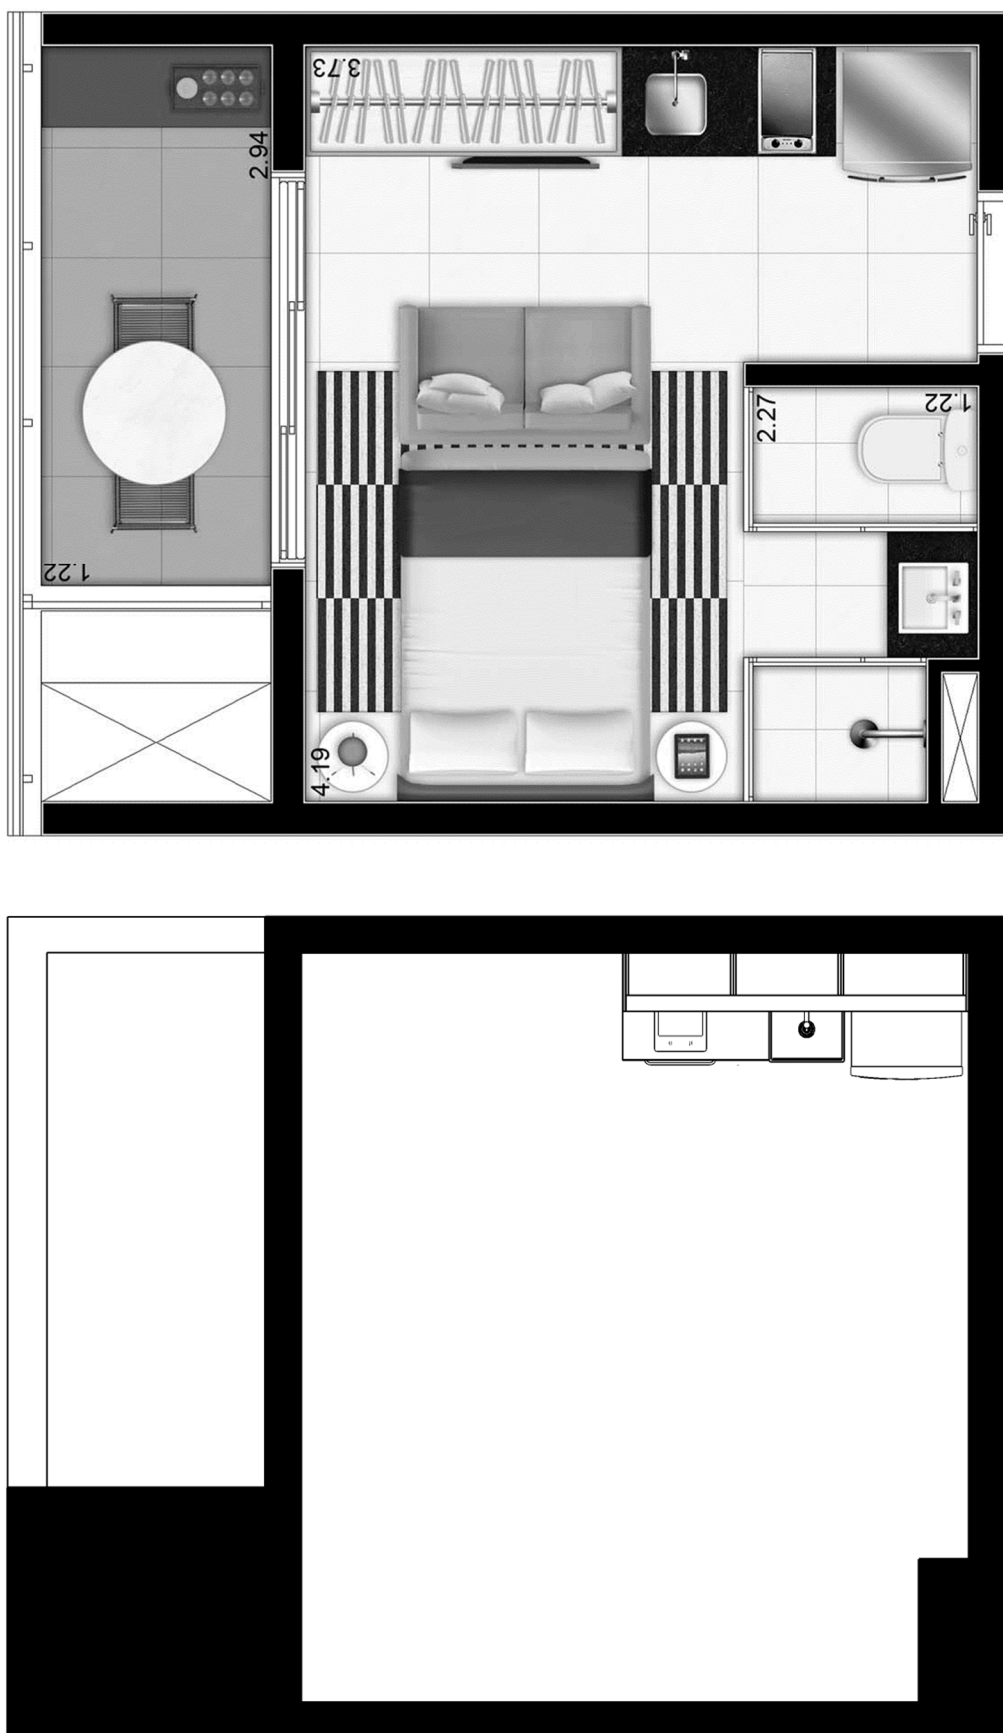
Acima: planta baixa do empreendimento VN Quata. Abaixo: planta baixa da simulação da instalação do sistema modular proposto. Fonte da imagem: acima disponível em www.vitacon.com.br (acedido fev. 2018) abaixo elaborada pelo autor.
